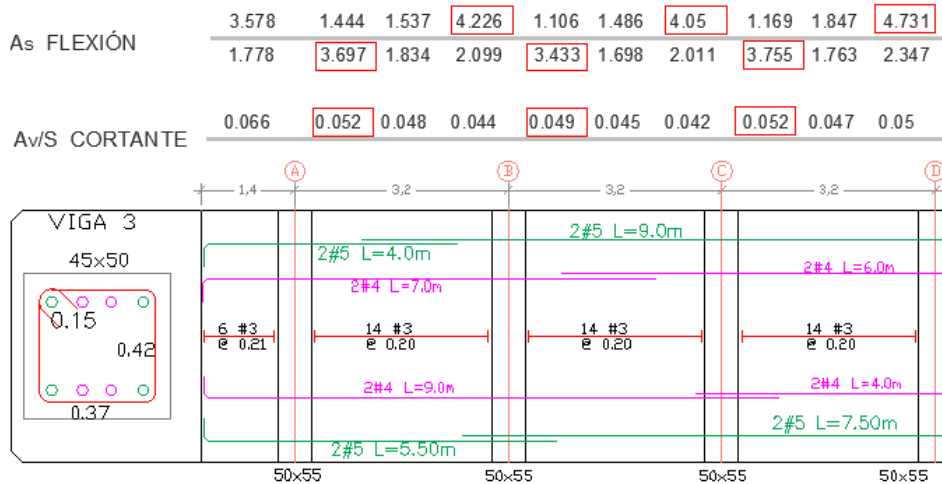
Cuantías obtenidas por esfuerzo a flexión, cortante y despiece de la viga 3 de la planta estructural.
